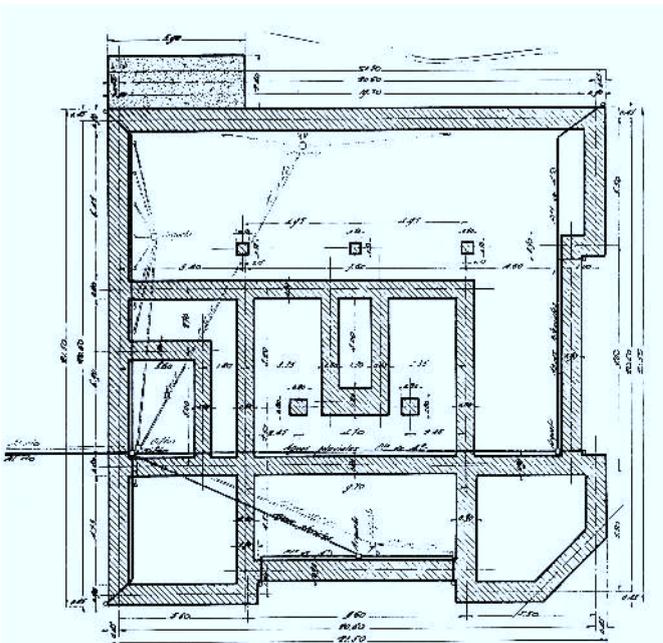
Proyecto para el Ayuntamiento de Carranza realizado en 1924 por el arquitecto Julio Sáenz de Barés. Planta de cimentación y saneamiento. (Edificio no construido).
